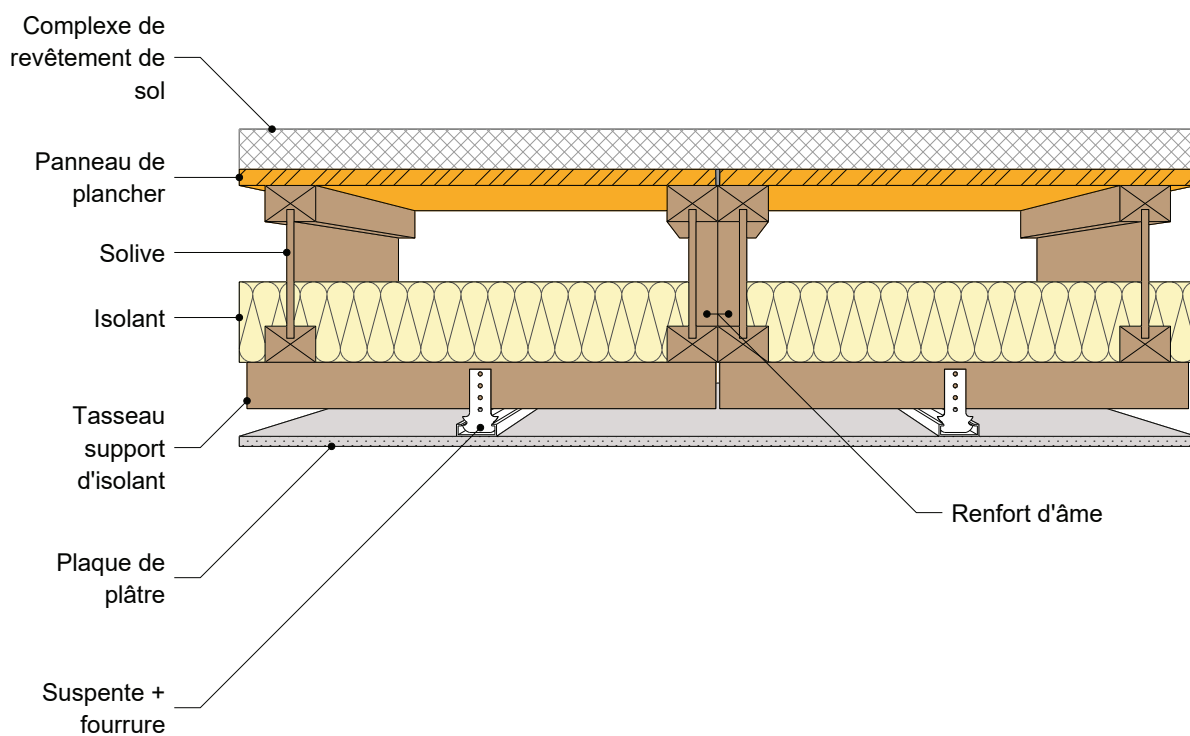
Plancher préfabriqué avec solivage poutre en I selon Avis Technique / DTA
